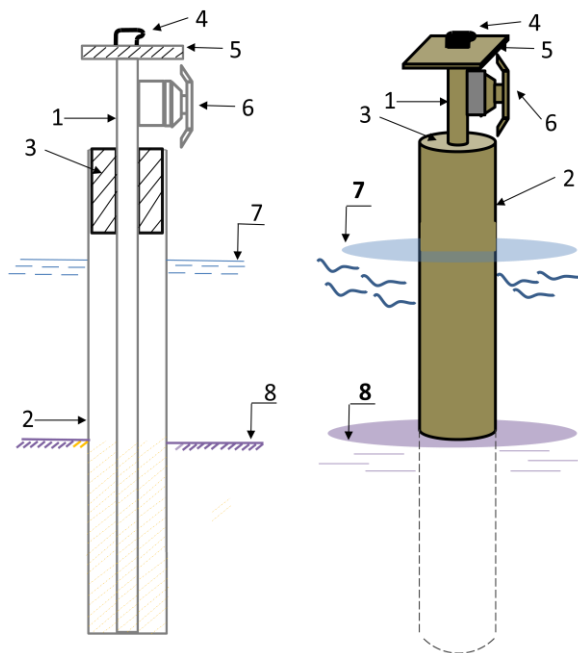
Швартовно-отбойный пал: разрез и 3D вид:
